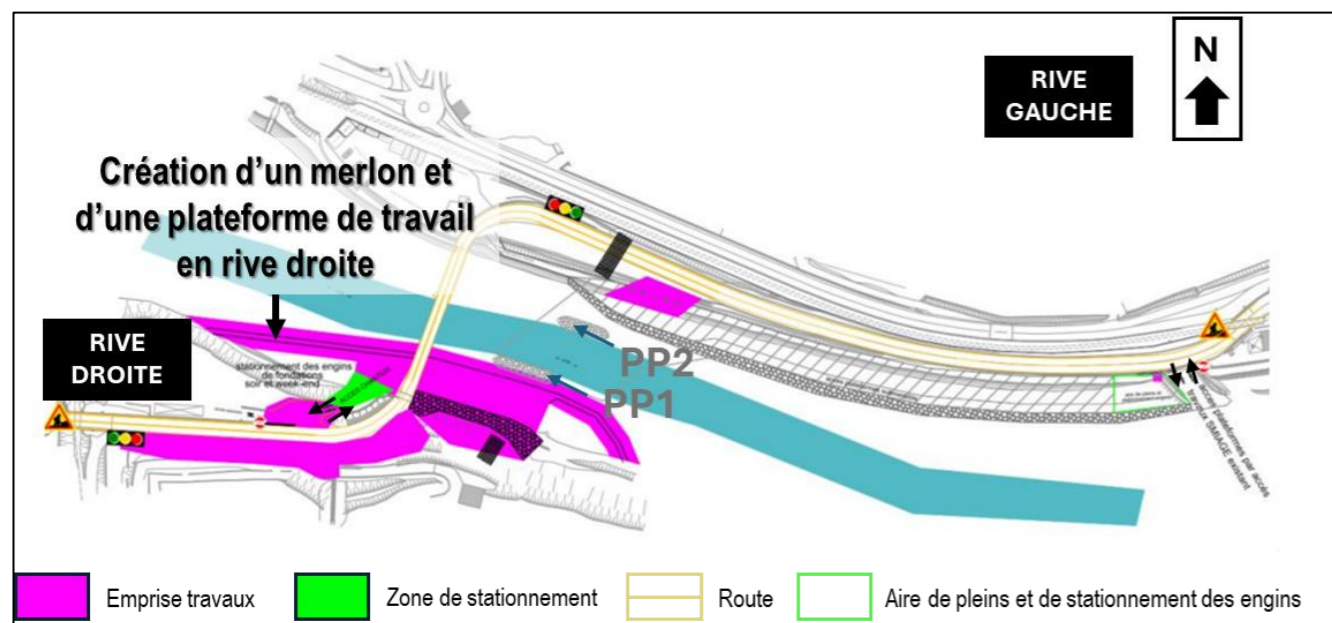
Dérivation du Var pour la construction du nouveau pont
